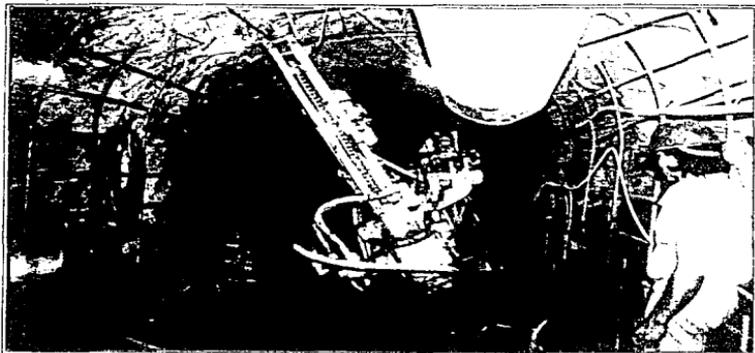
Track drill de pluma recortada barrenando en el interior de la galería, obsérvese que el revestimiento no se ha realizado.
